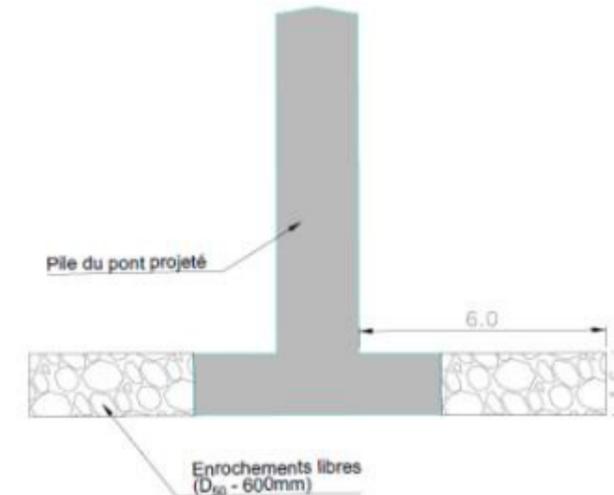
coupe de la protection de la pile (source : Étude de confortement des berges, Artelia – octobre 2024)
